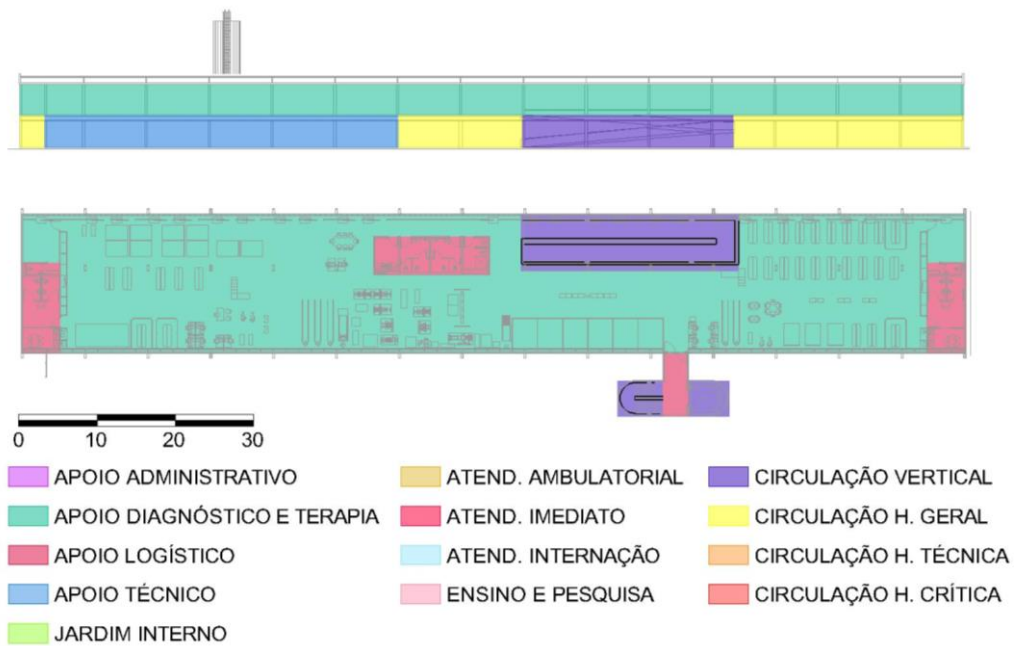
Setorização Sarinha bloco A, segundo pavimento e corte longitudinal.
